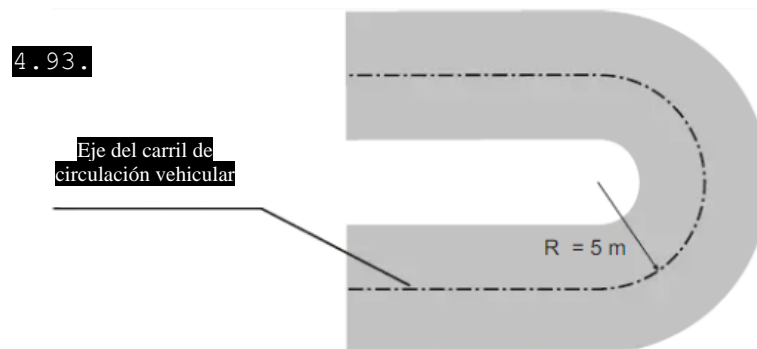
Radio de giro. (Ministerio de Vivienda, 2021)
